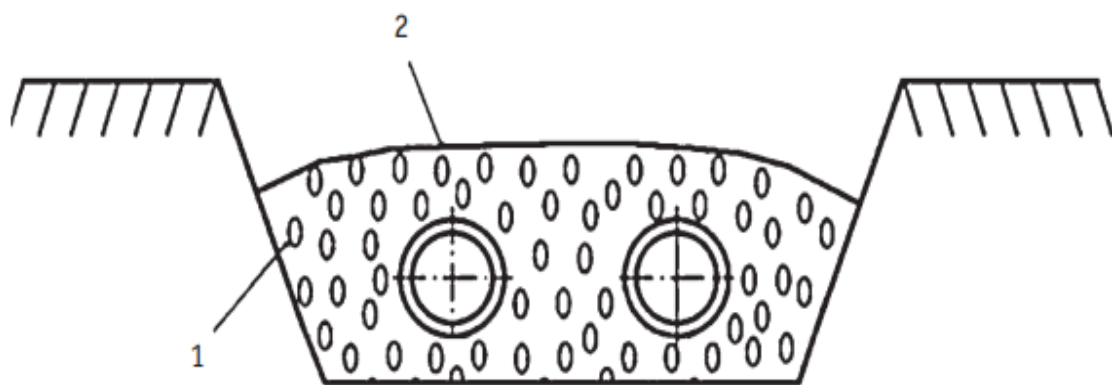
Насыпная теплоизоляция для хризотилцементных труб
